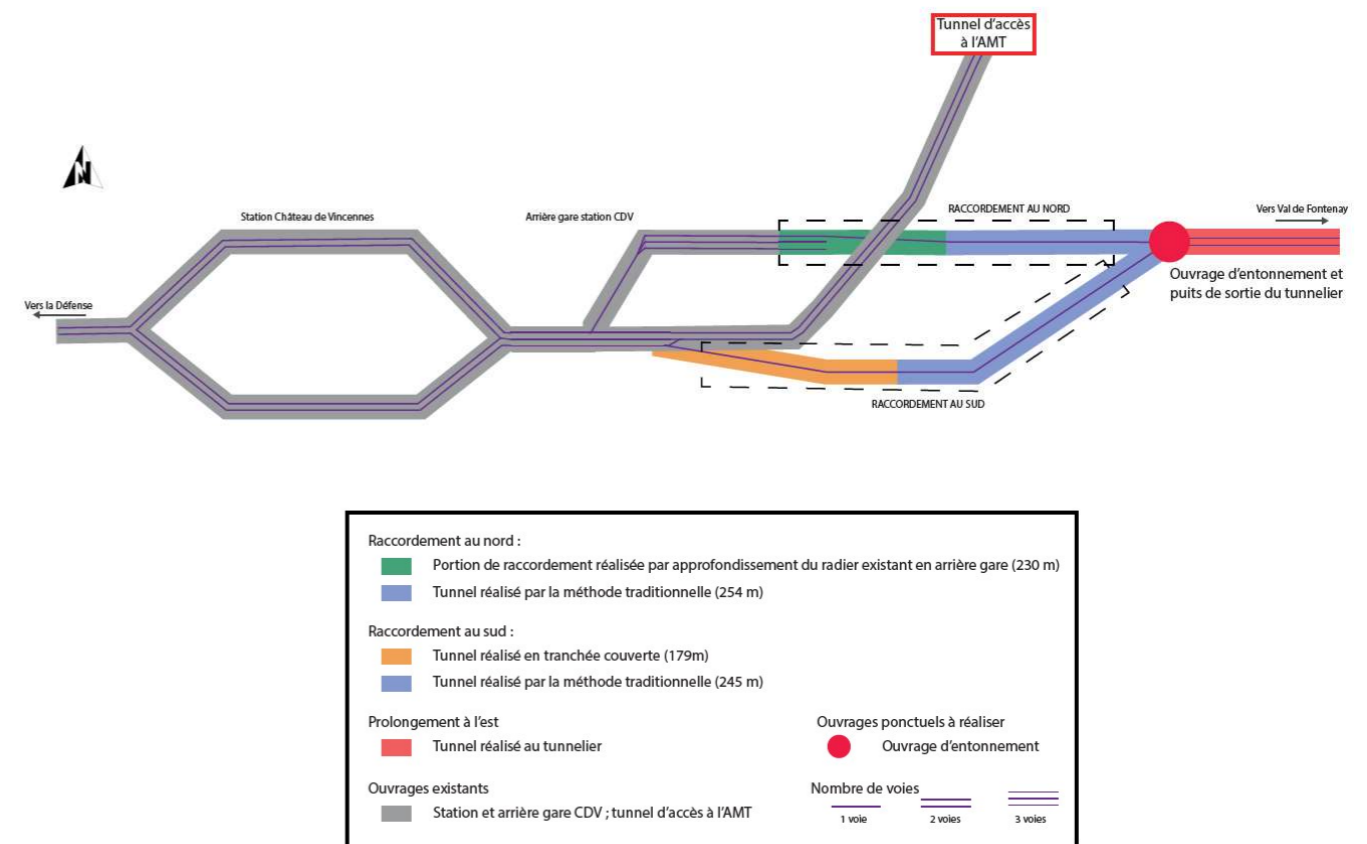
Méthodes constructives du raccordement au tunnel de la ligne existante (Sources : Ingérop sur la base de données RATP)
